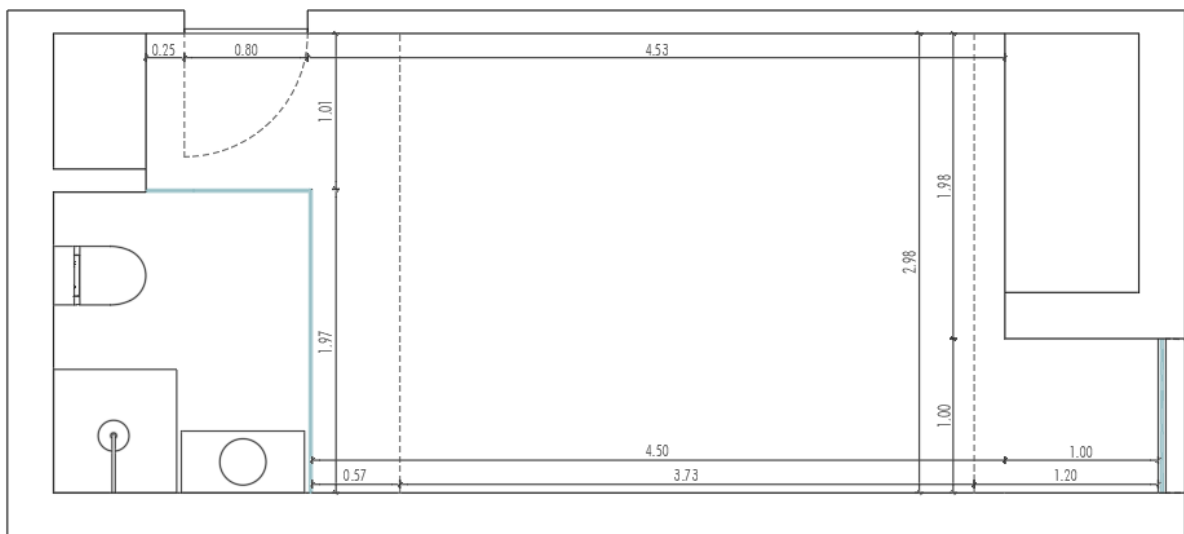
Planta existente do escritório (Fonte: Autora, 2023)
